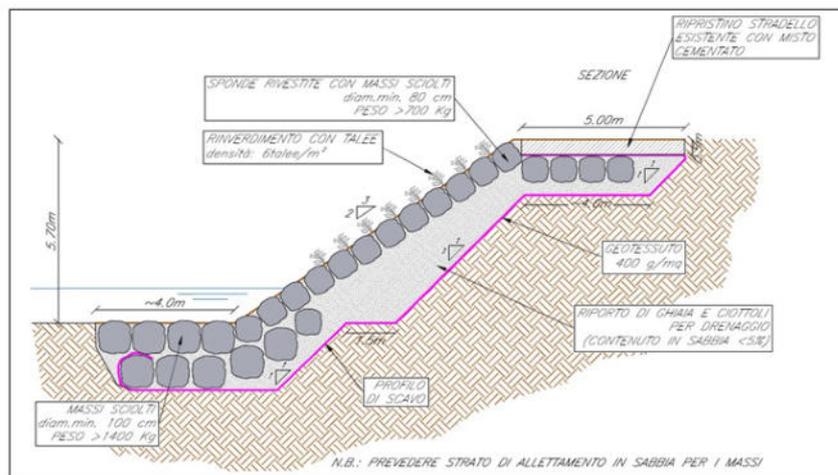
Sezione trasversale progetto definitivo (rel. 2018)
